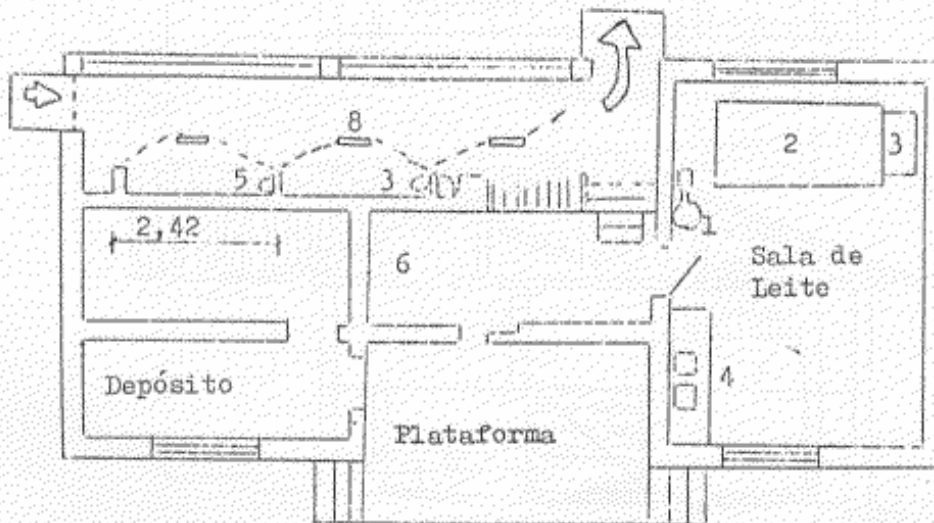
Detalhes da Construção da Sala de Ordenha
